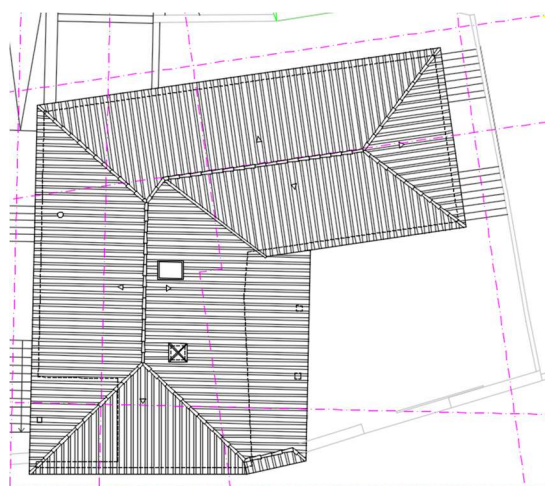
Planta de arquitetura final da cobertura (sem escala).
